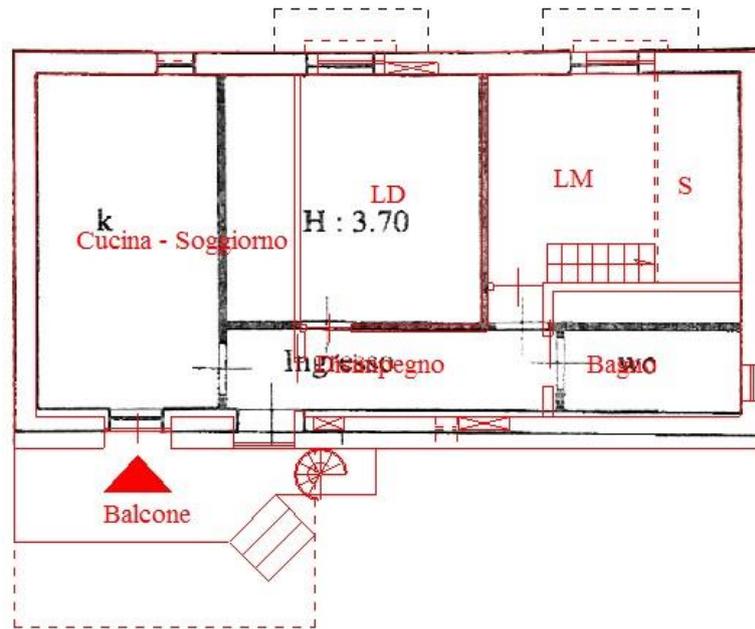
sovrapposizione della situazione reale dei luoghi e della planimetria catastale del piano rialzato.
